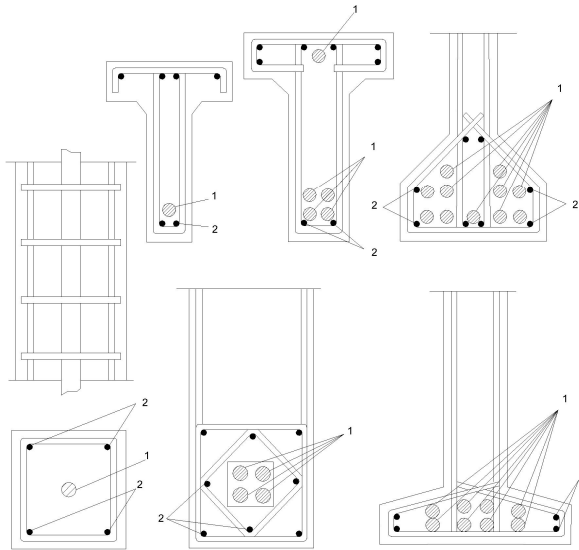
Схема розташування арматури у поперечному перерізі конструкції:
